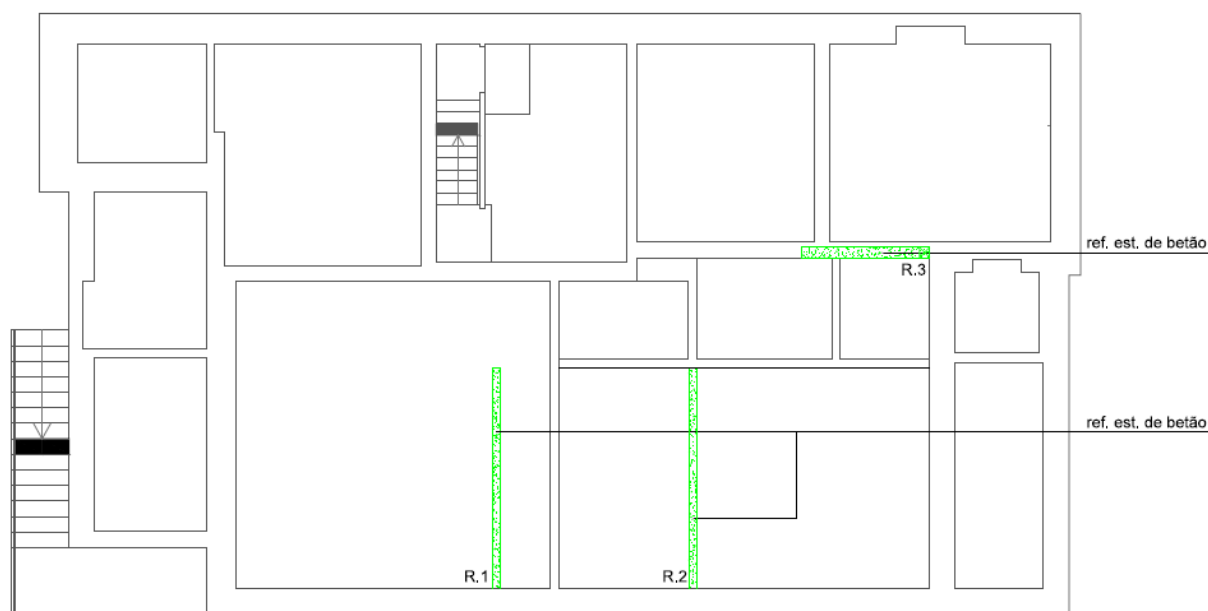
Elementos estruturais em betão armado colocados posteriormente
